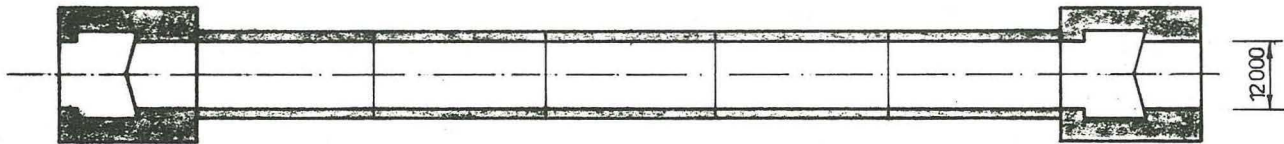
Druckluftgründung für die Schleusenhäupter und für die Schleusenkammer (Variante 2)
